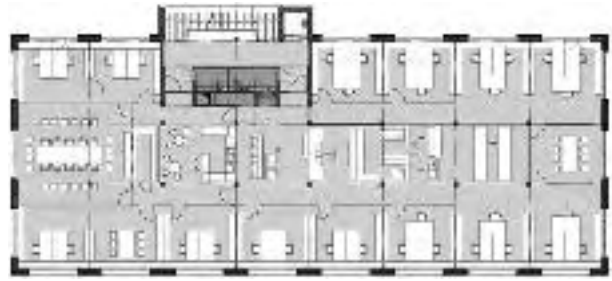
Grundriss, 2. OG (Quelle: Hahn Helten Architekten)
